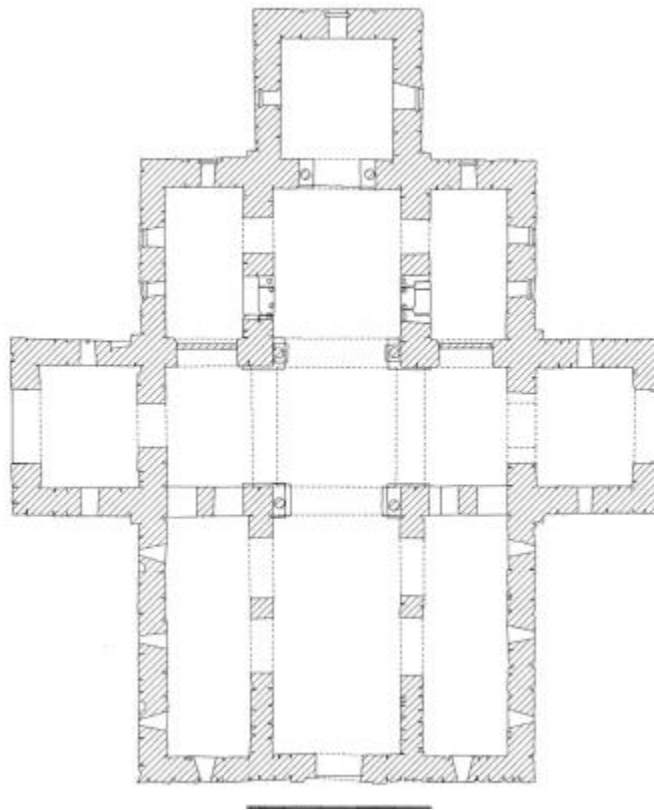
Planta de San Pedro de la Nave, Zamora, siglo VIII.
